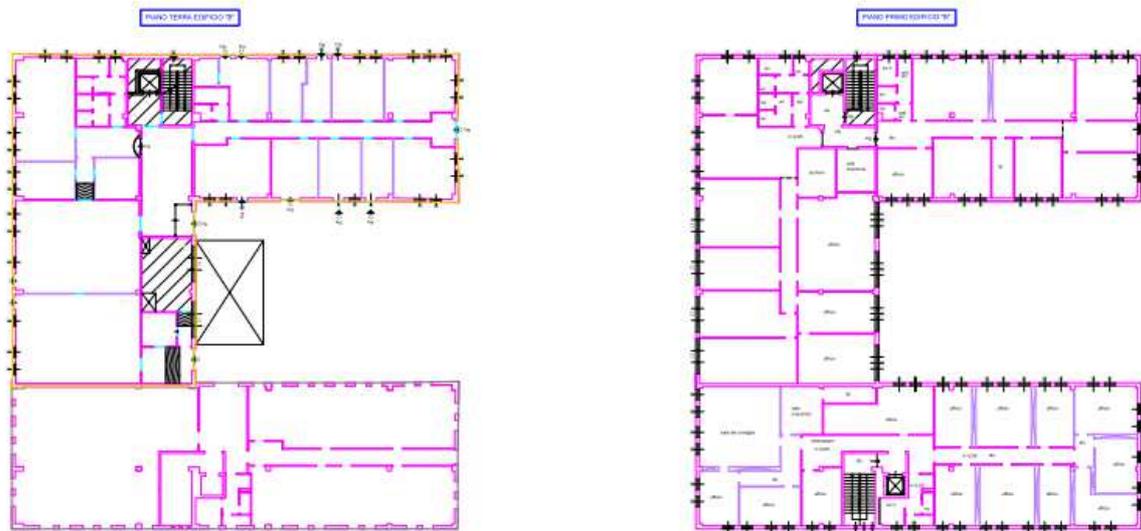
Palazzina B -Piano Piano Terra e Piano Primo
